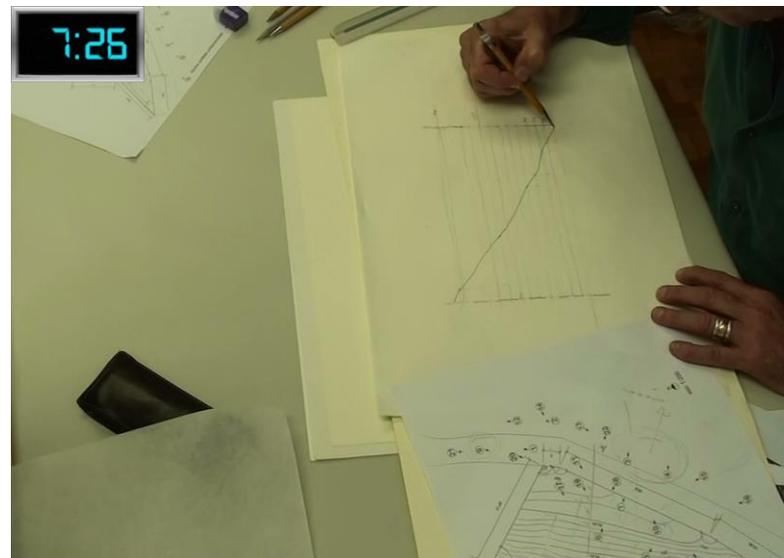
Arquiteto desenhando o perfil do terreno no corte com escala 1:100.
